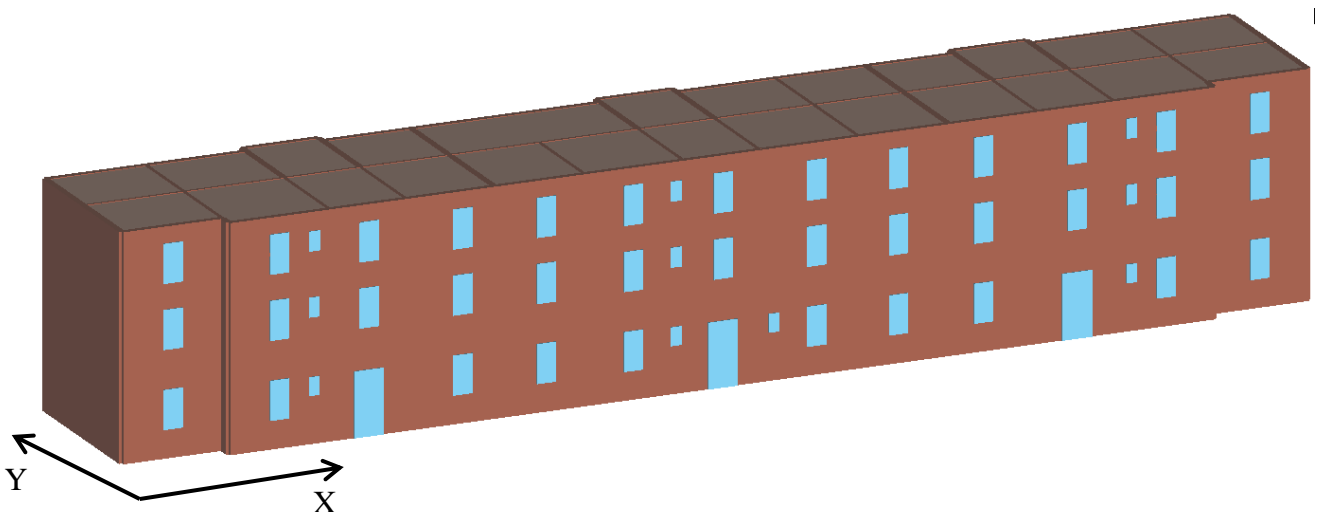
Modello SDF, vista 1 prospetto fronte strada
